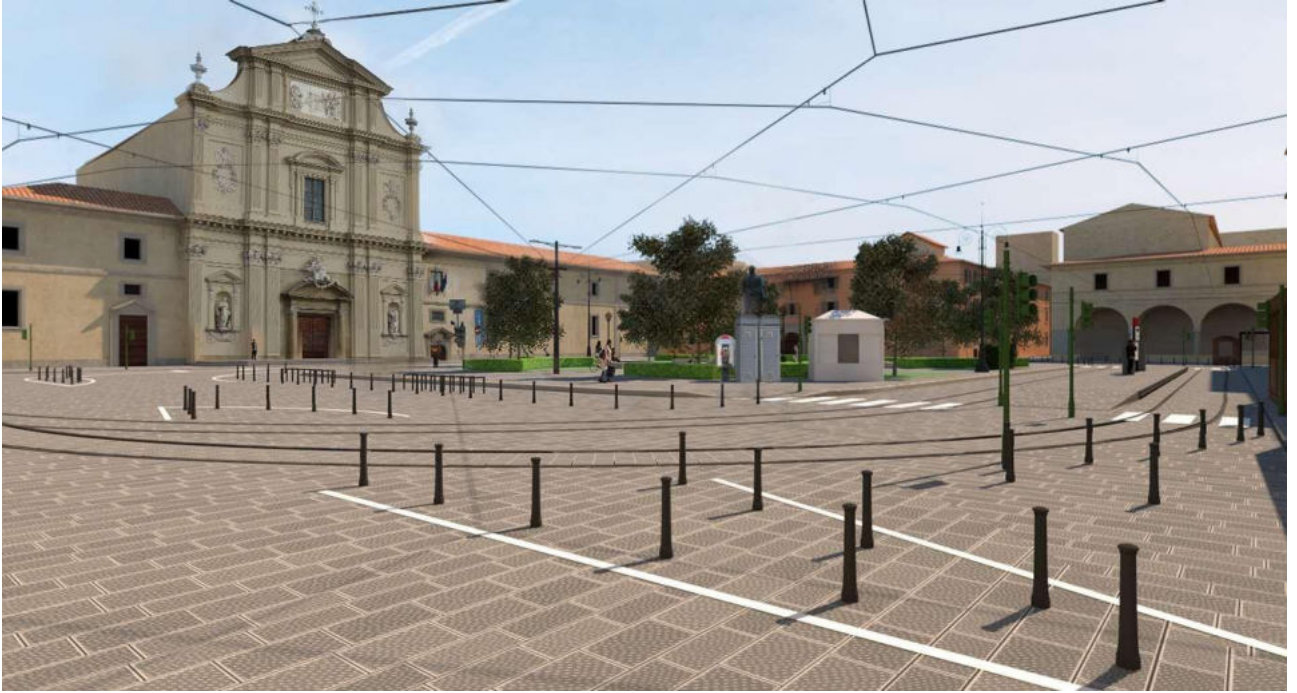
Progetto Esecutivo – Fotoinserimento piazza San Marco con tessitura pavimentazione
